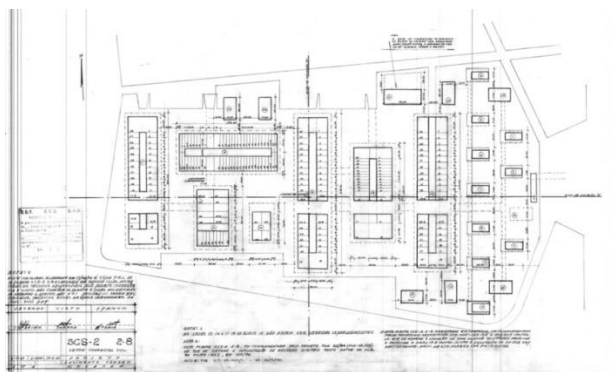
Projeto urbanístico do SCS - Planta de Térreo
